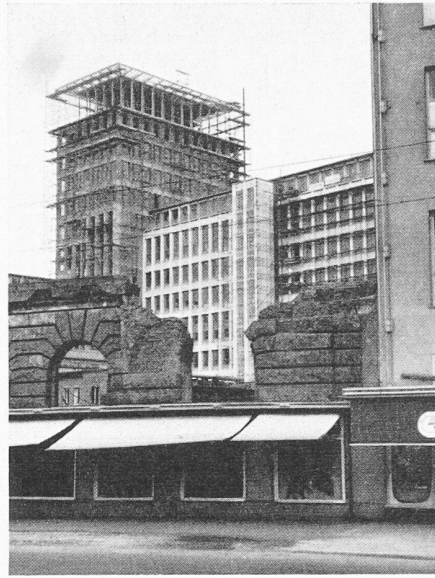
Der Turm der Fernmeldebauten. Im Vordergrund noch zerstörte Geschäftsstrasse, in der einstöckige Ladenbauten so lange provisorisch eingerichtet sind, bis die Finanzierung des Wiederaufbaues sichergestellt ist
